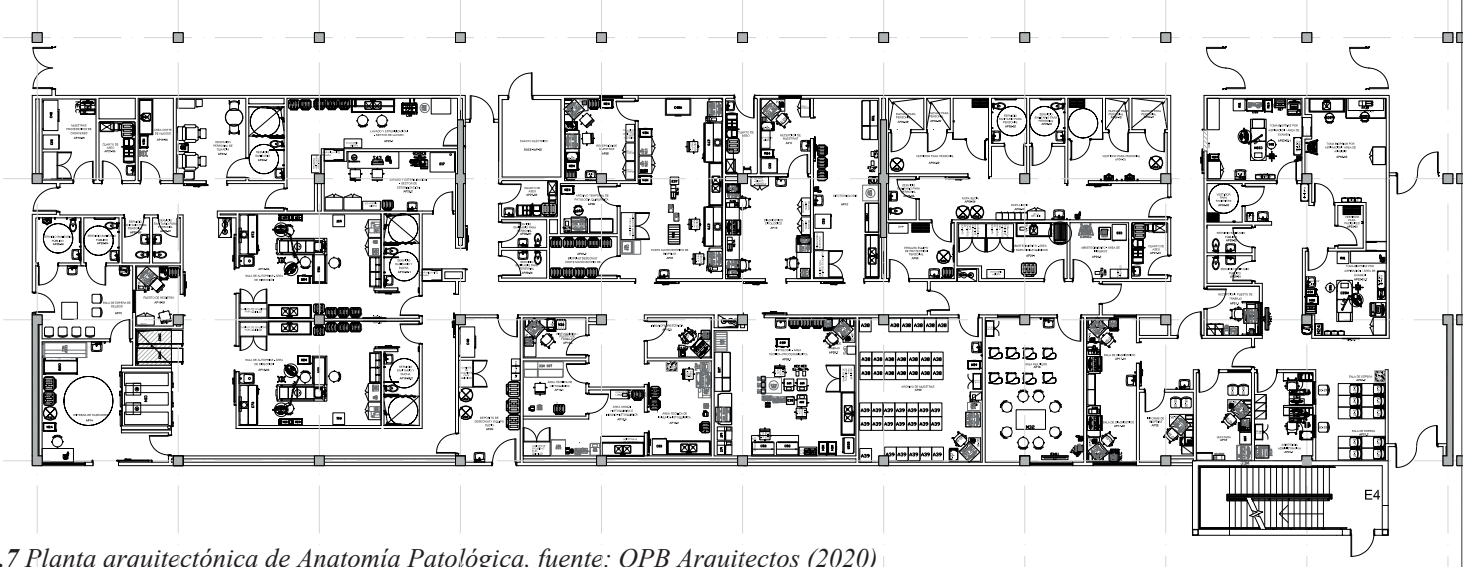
Planta arquitectónica de Anatomía Patológica, fuente: OPB Arquitectos (2020)
